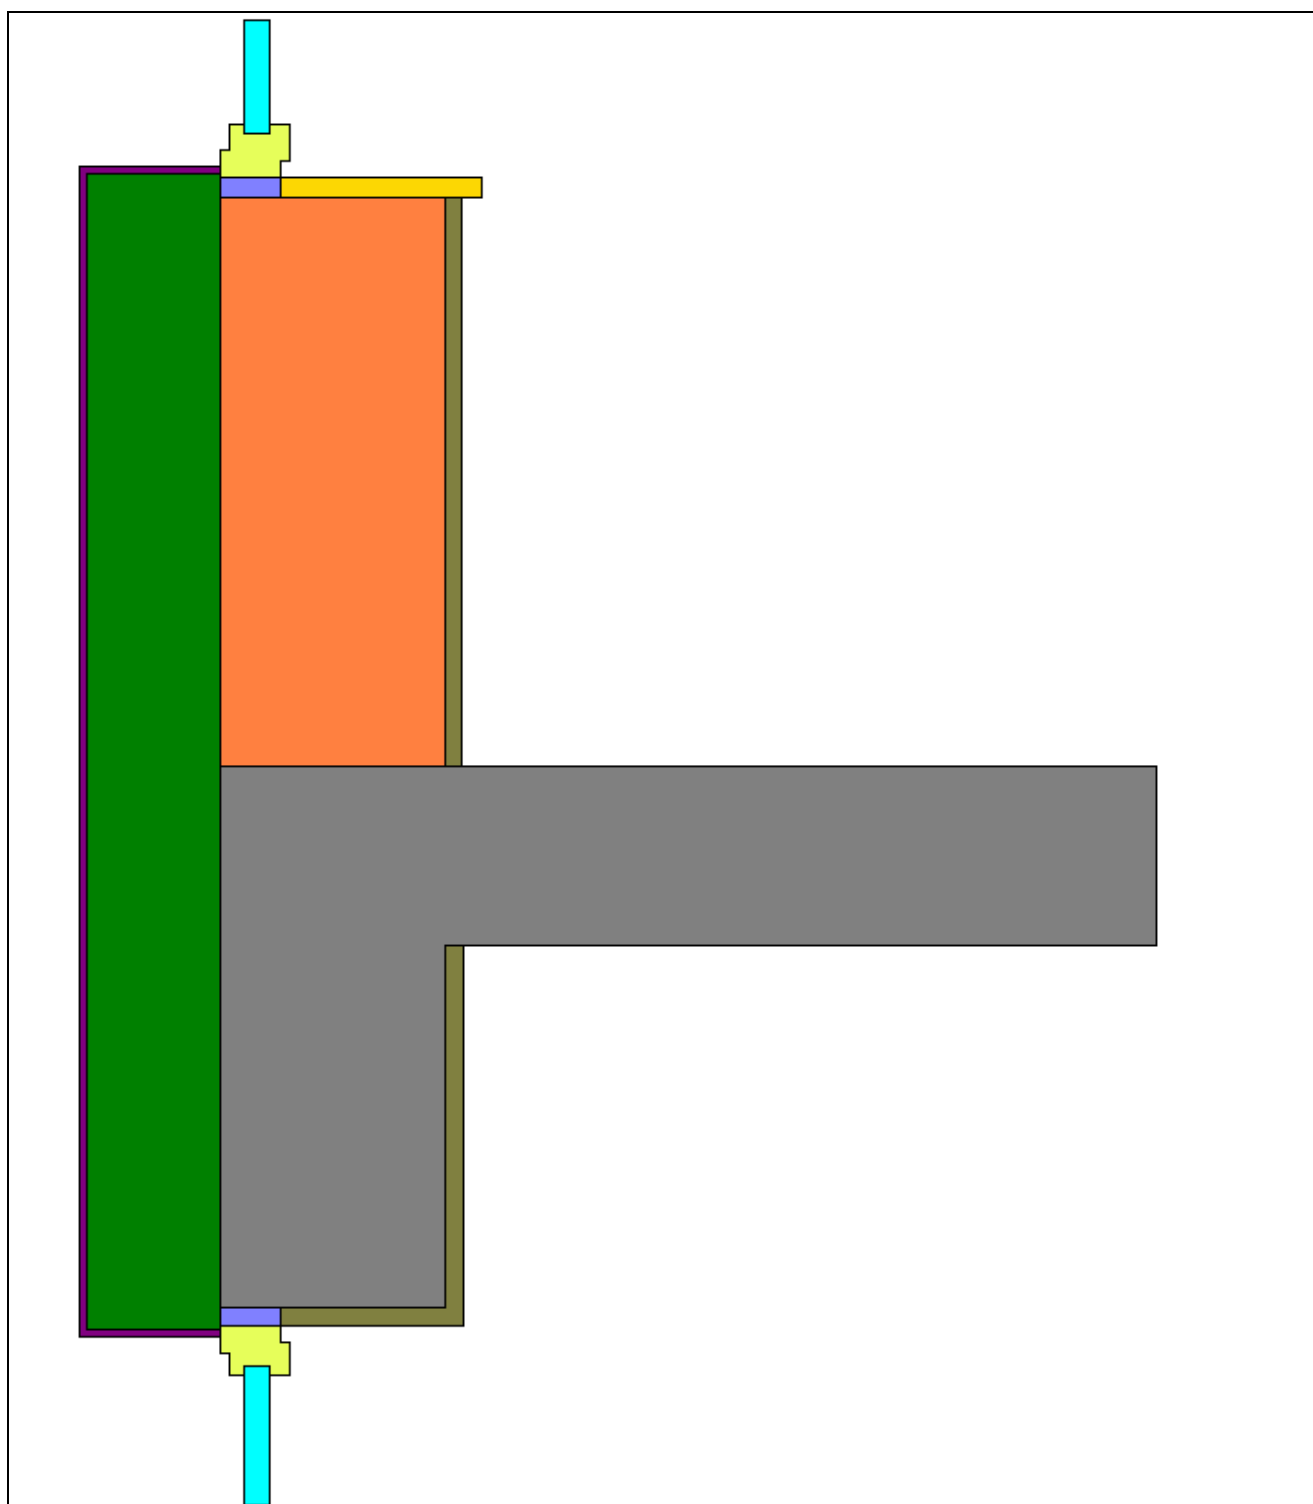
Схематическое изображение вертикального разреза стены с теплоизоляционным фасадом в зоне расположения светопроемов с оконными блоками.
